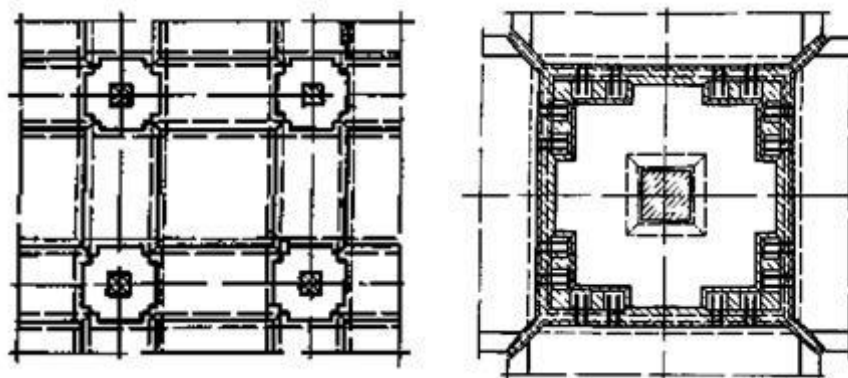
Конструкції збірних безбалкових перекриттів: *а* – план розкладки збірних плит; *б* – вузол спирання плит на капітель
